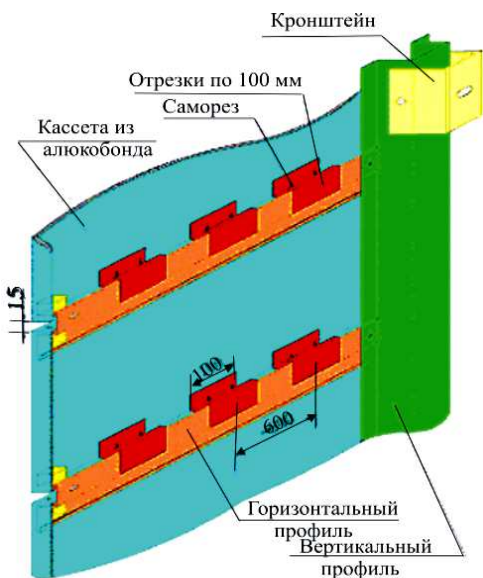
Схема подвесной фасадной системы Алюкобонд (вид изнутри)
